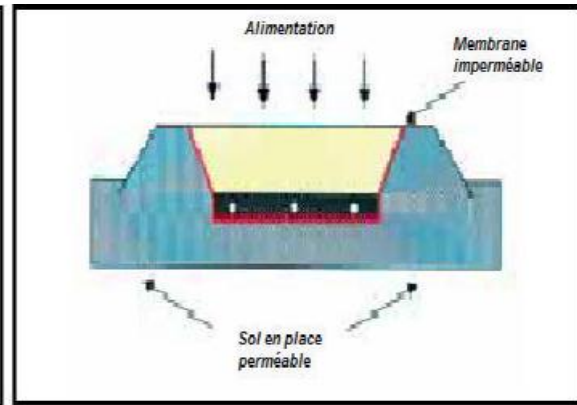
Système drainé avec un massif drainant étanché par une membrane imperméable
